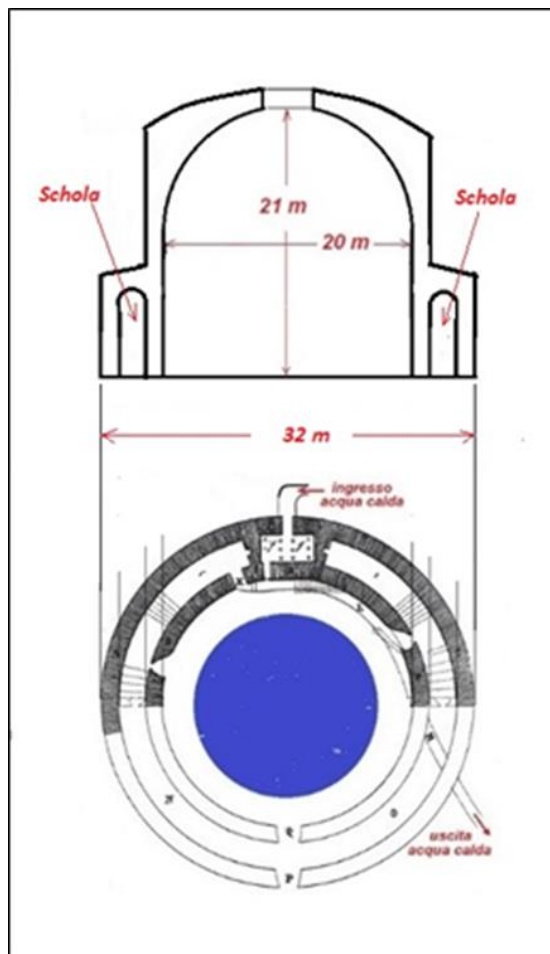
(Pianta e alzato delle antiche terme di Himera)
